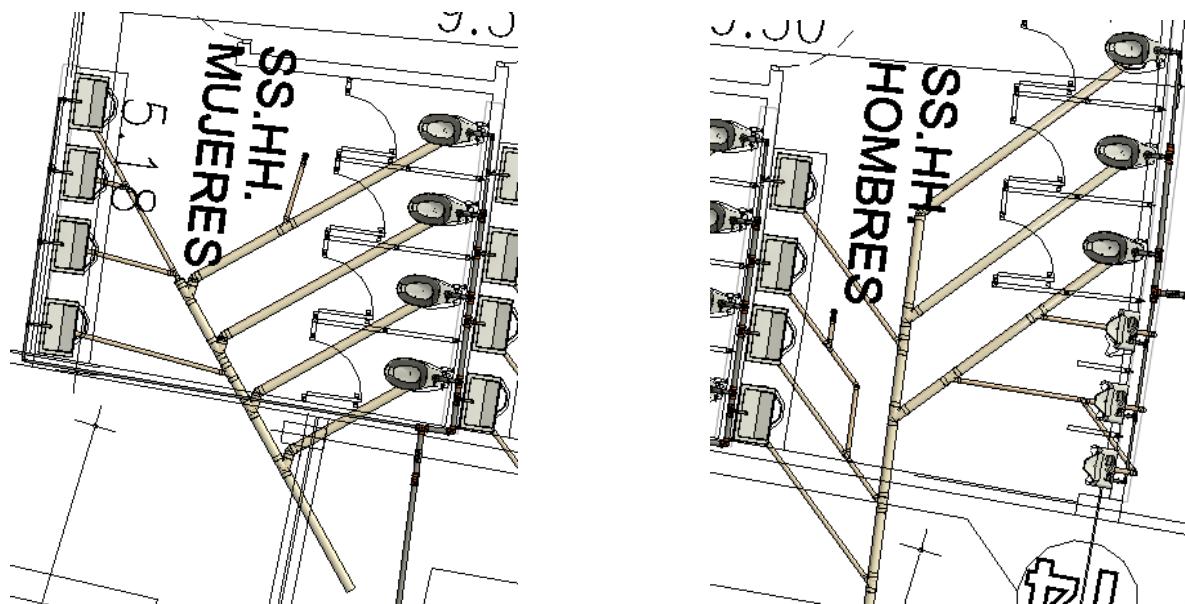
Implantación de red exterior de alcantarillado sanitario.
